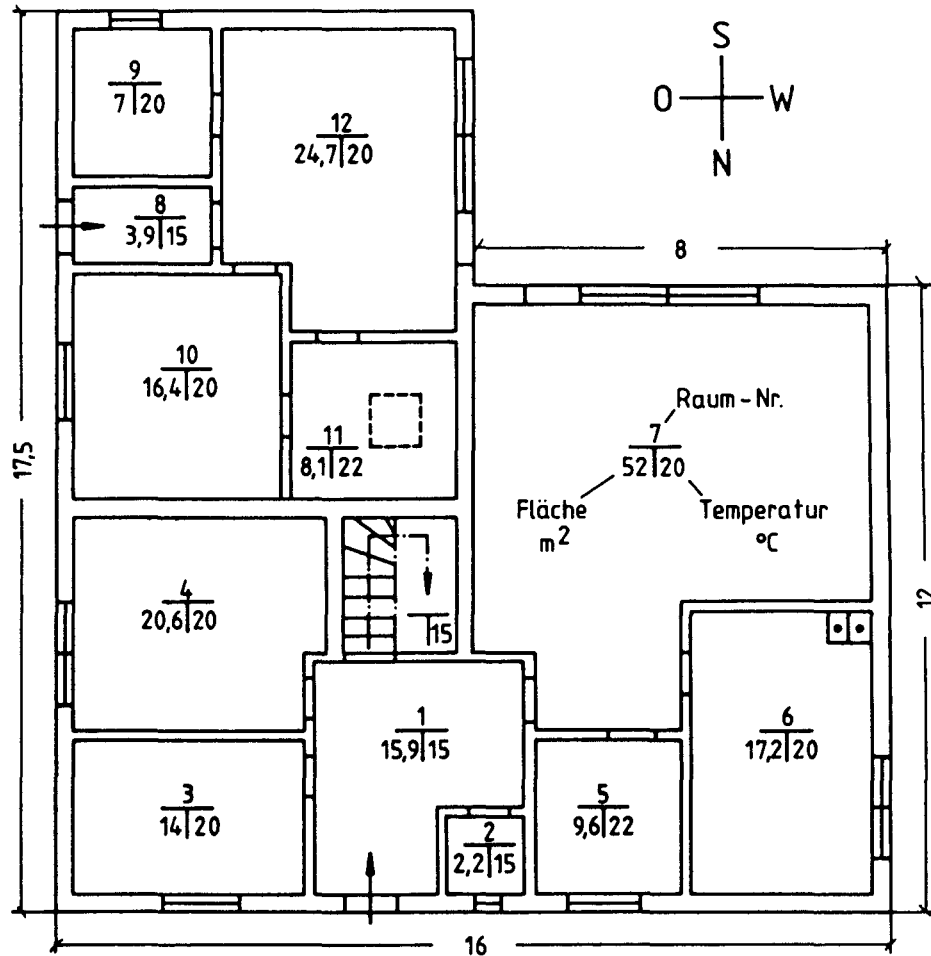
Grundriß (M 1:100) des Zweifamilien-Winkelbungalows (Flachdach)
